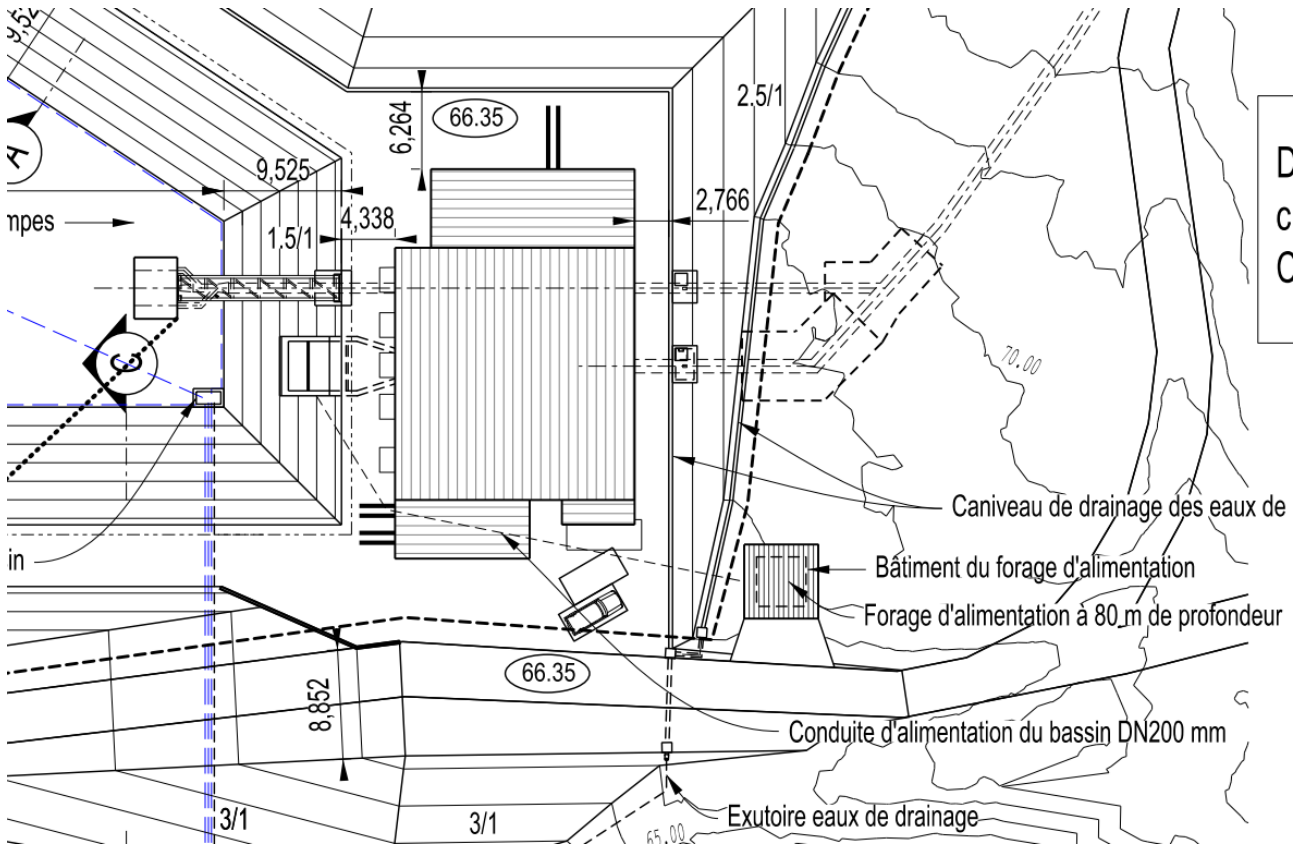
plan du forage d'alimentation en eau du bassin inférieur
